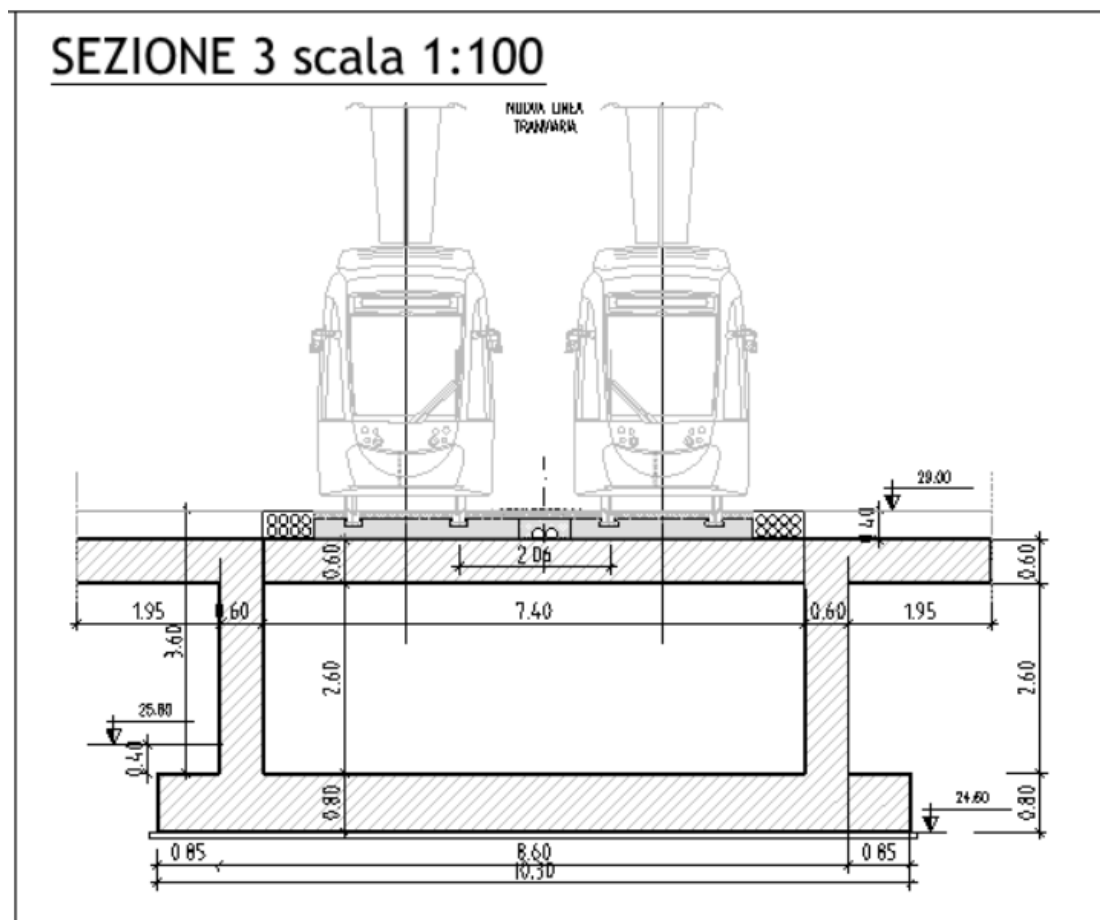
Sezione trasversale 3-3 capolinea in corrispondenza delle pensiline laterali
